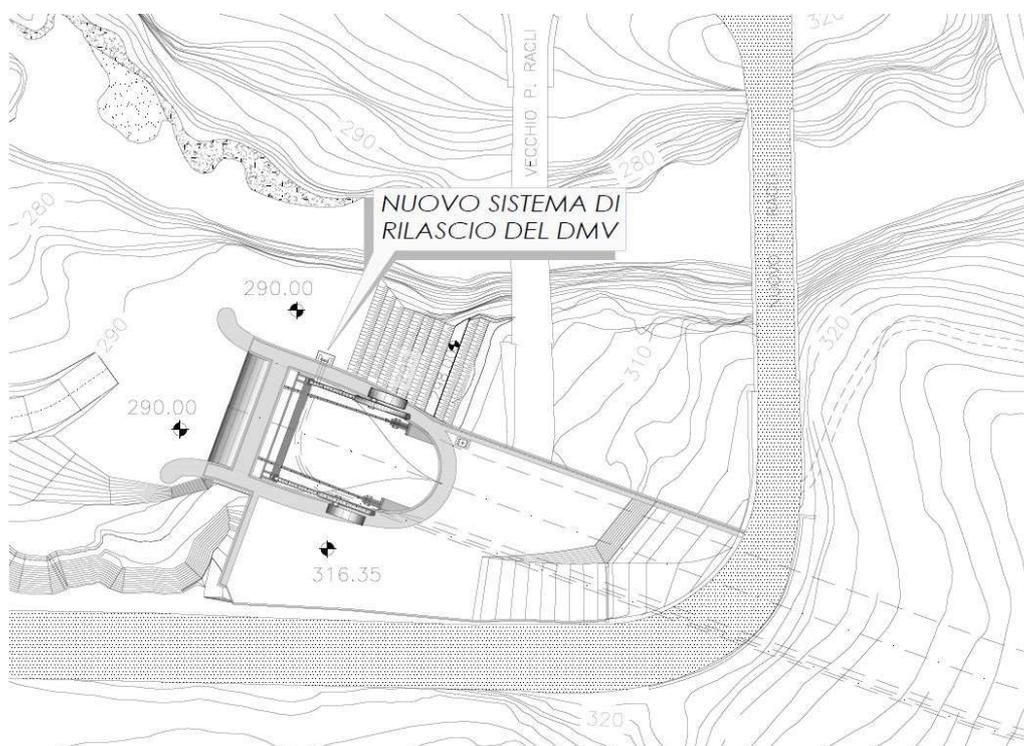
Planimetria imbocco nuovo scarico di superficie in sponda destra
